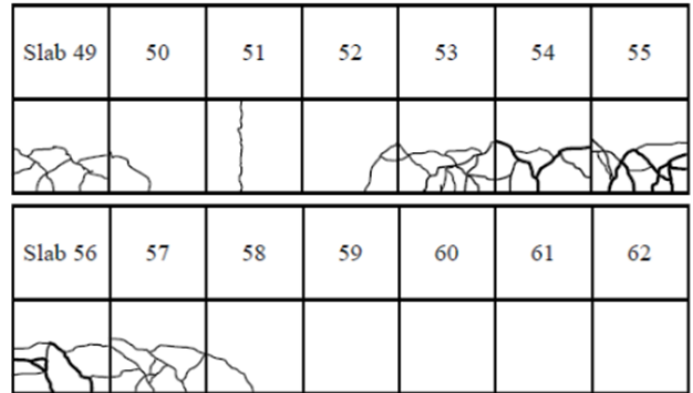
Sección Sur, agrietamiento final después de 234,000.0 ESALs, losas 49—55 de hormigón liso y 56-62 losas de hormigón reforzado con fibras de 9 cm de espesor. Fuente: [4].
